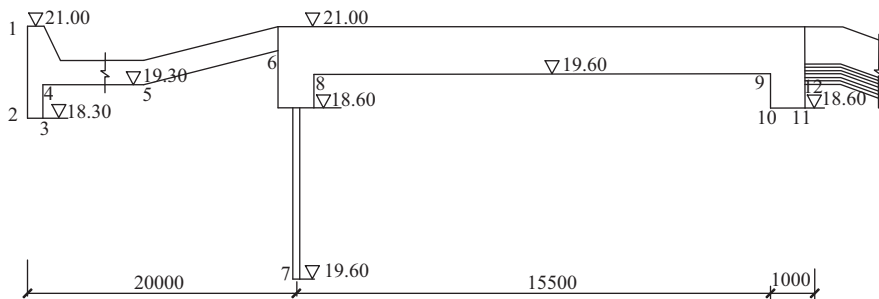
闸基防渗布置轮廓线(高程单位:m,尺寸单位:mm)
